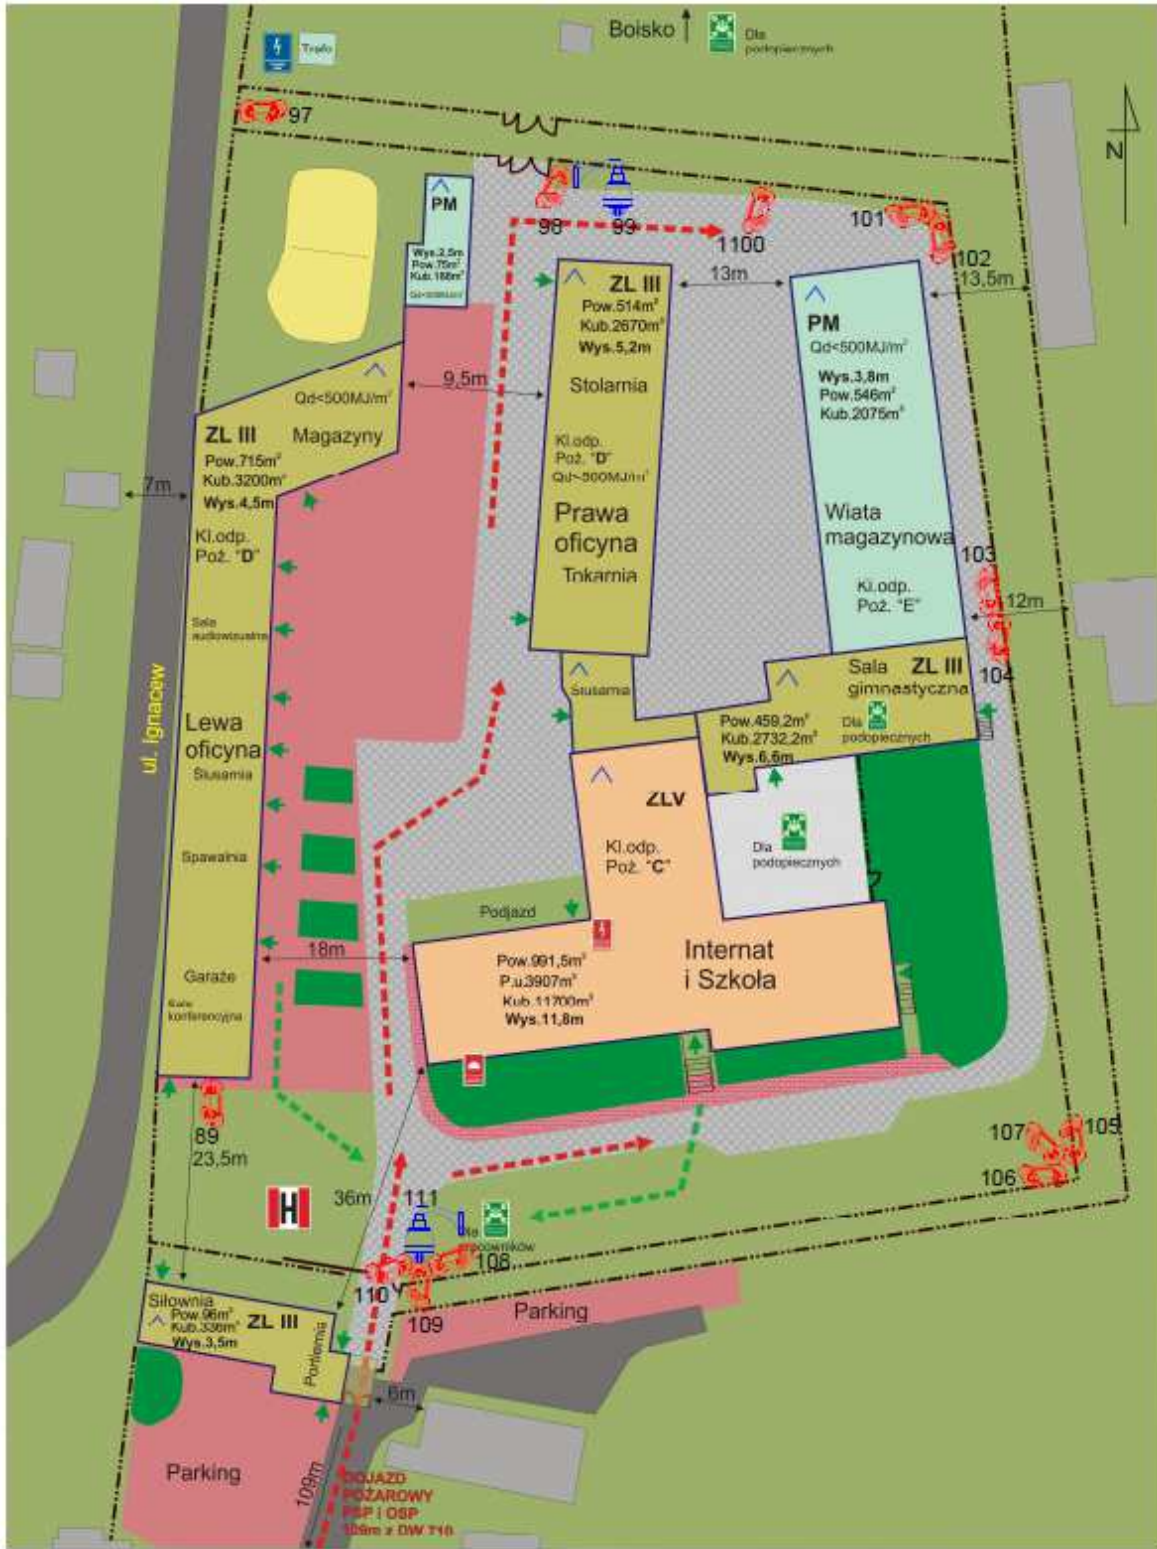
Plan rozmieszczenia punktów kamerowych. Portiernia
